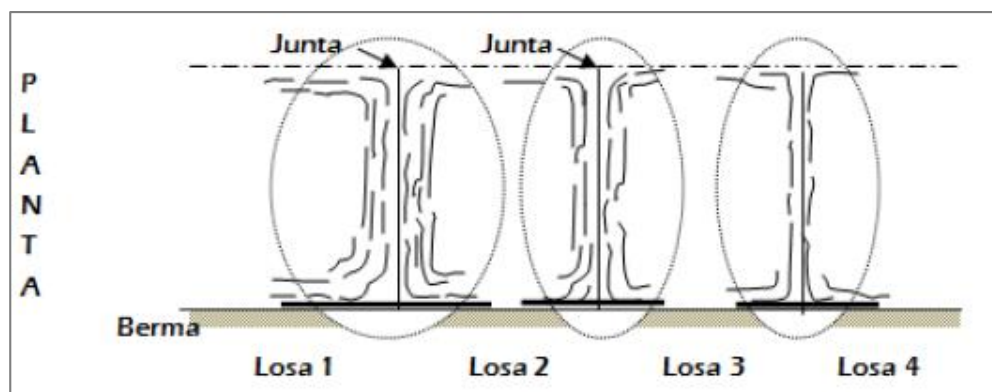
Esquema de la vista en planta de una grieta de durabilidad “D”.
